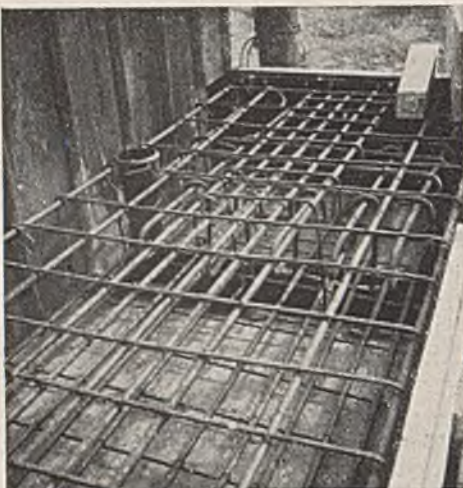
Bewehrung der Eisenbeton-Auflagerbank.
